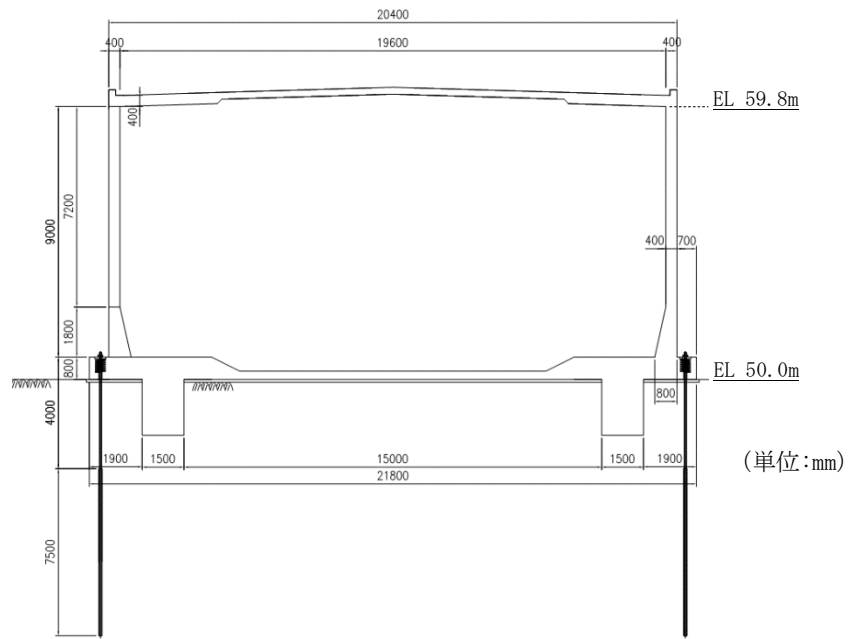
非常用ろ過水タンク 断面図 (A-A断面)
